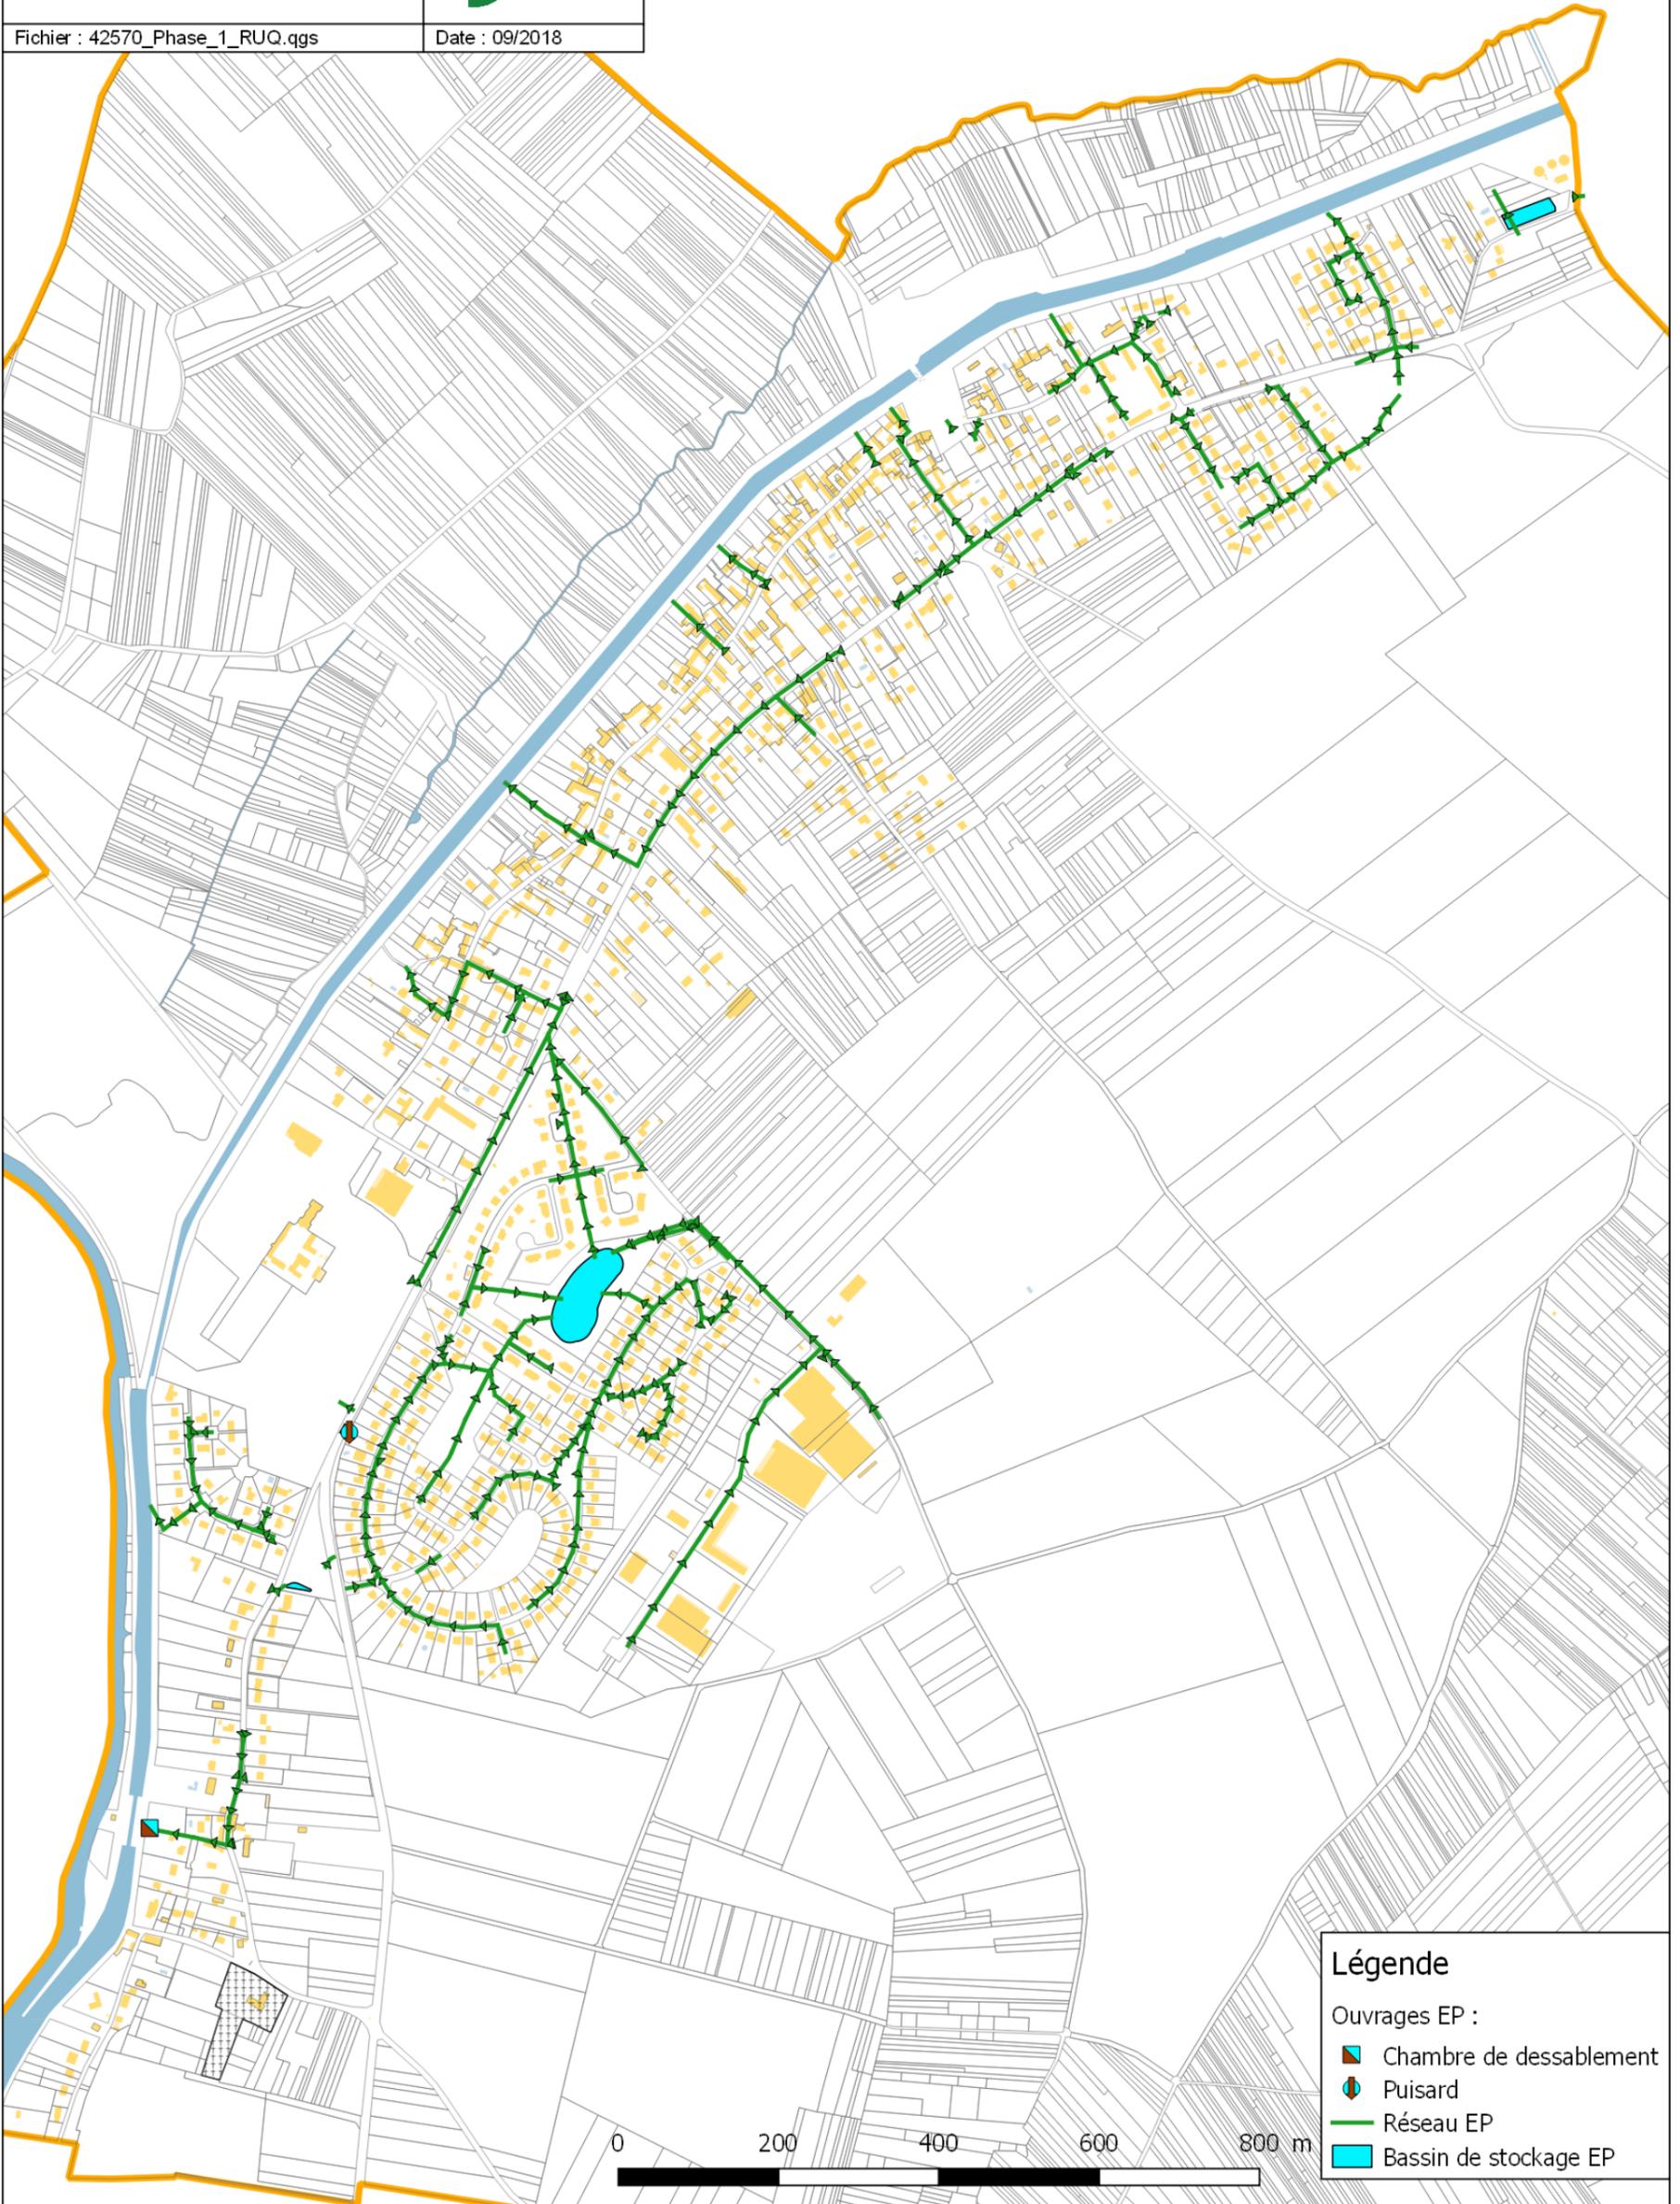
Plan du réseau d'assainissement des eaux pluviales
